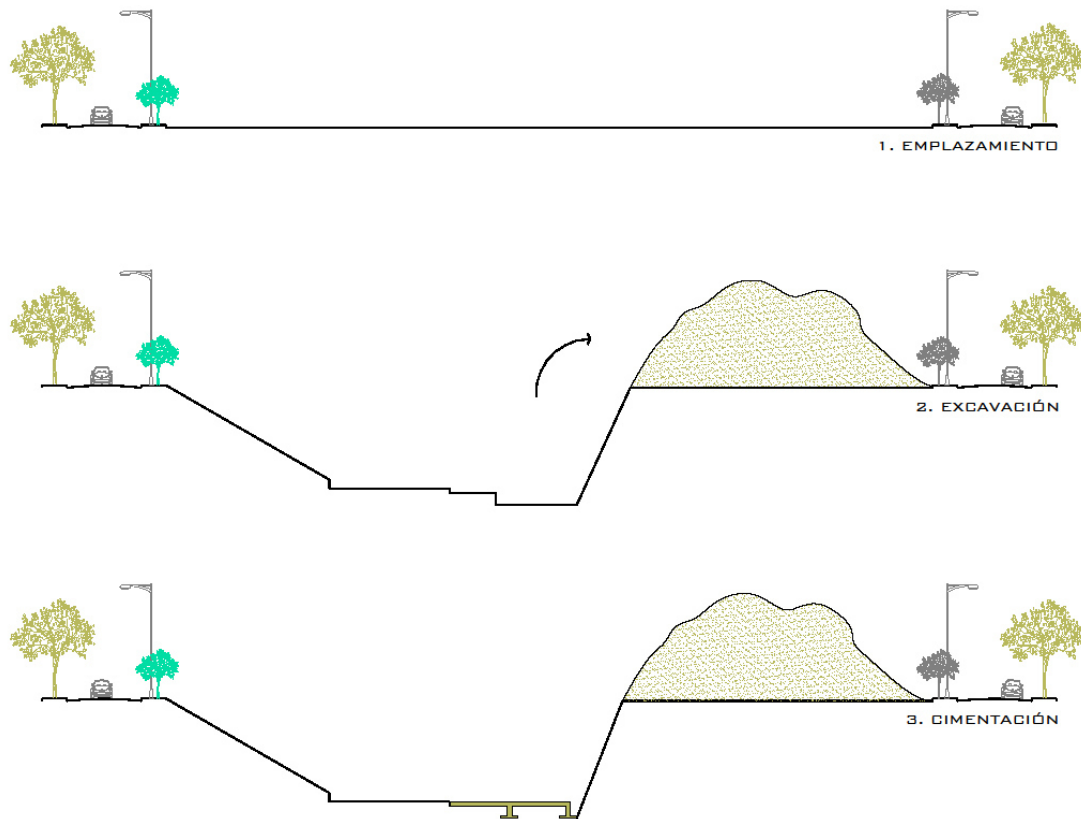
Sistema constructivo de los BPU. Fuente: Elaboración propia.
